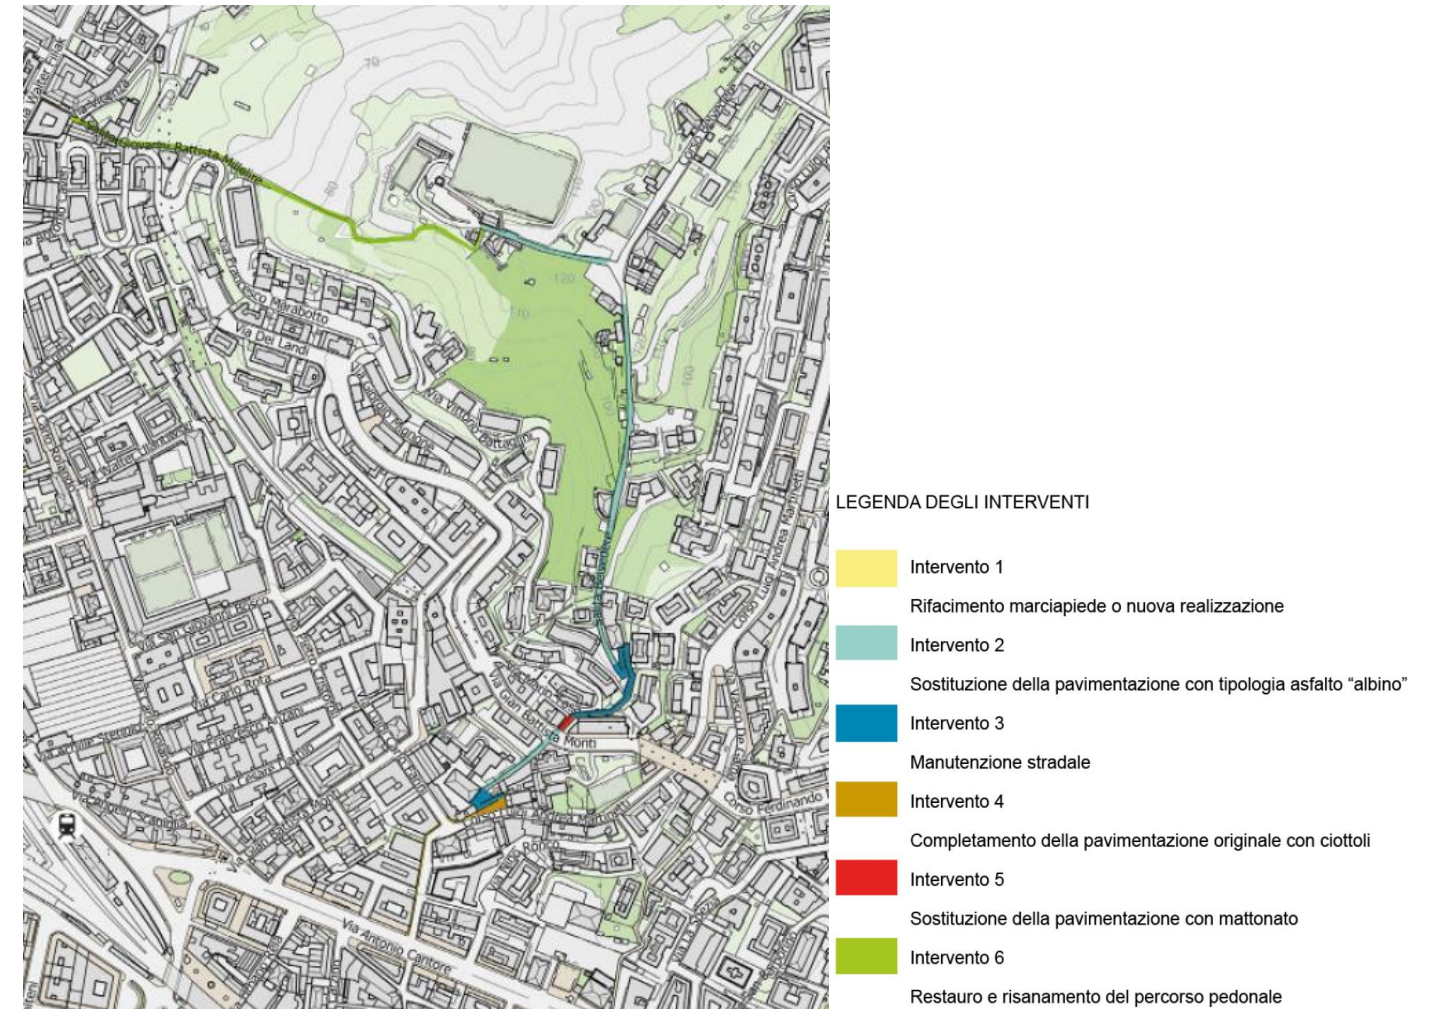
Planimetria aree di intervento di riqualificazione salita Millelire e salita Belvedere
